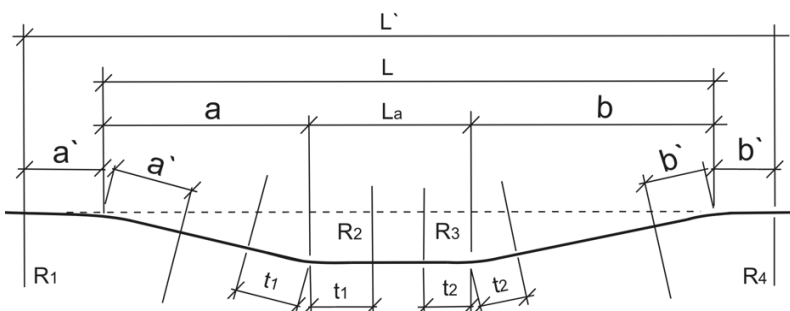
Elementet teknike minimale horizontale të vendndaljes së autobusit
